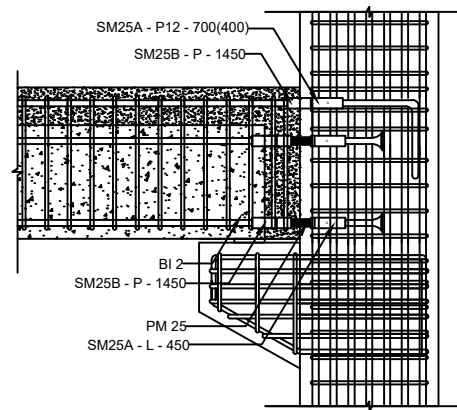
DETAIL SAMBUNGAN SINGLE SIDED BI 1 - BA 1 (DETAIL H)
